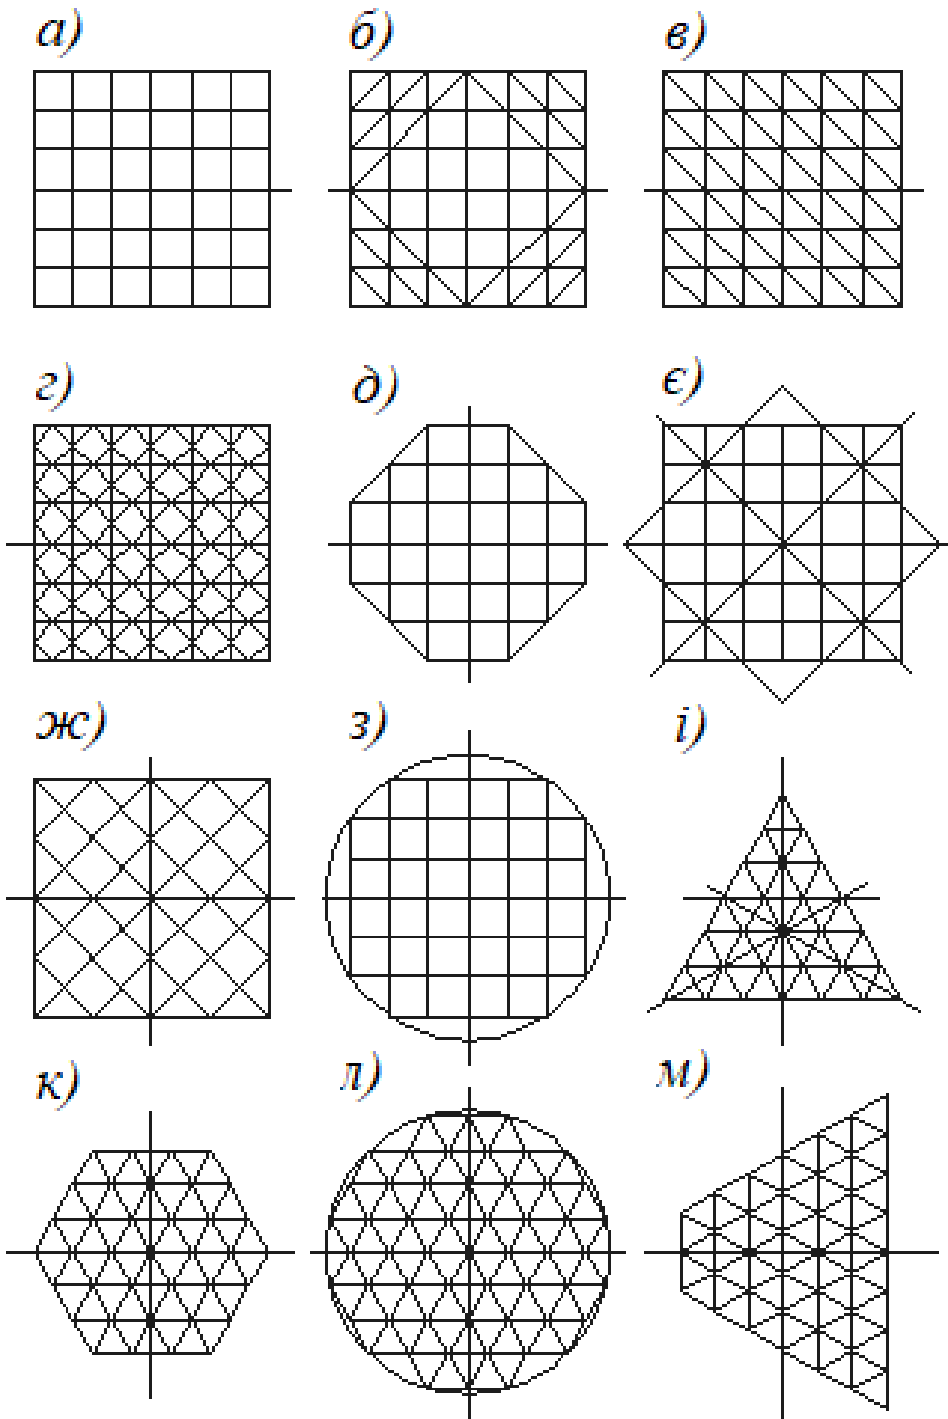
Основні схеми покриття з перехресних балок та ферм
